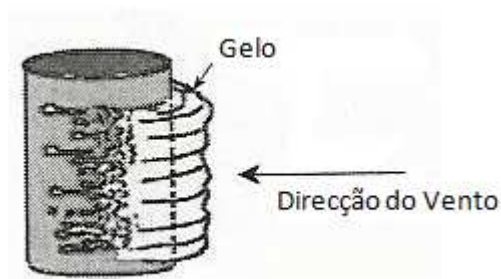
Secção instável devido ao aparecimento de gelo [5]
